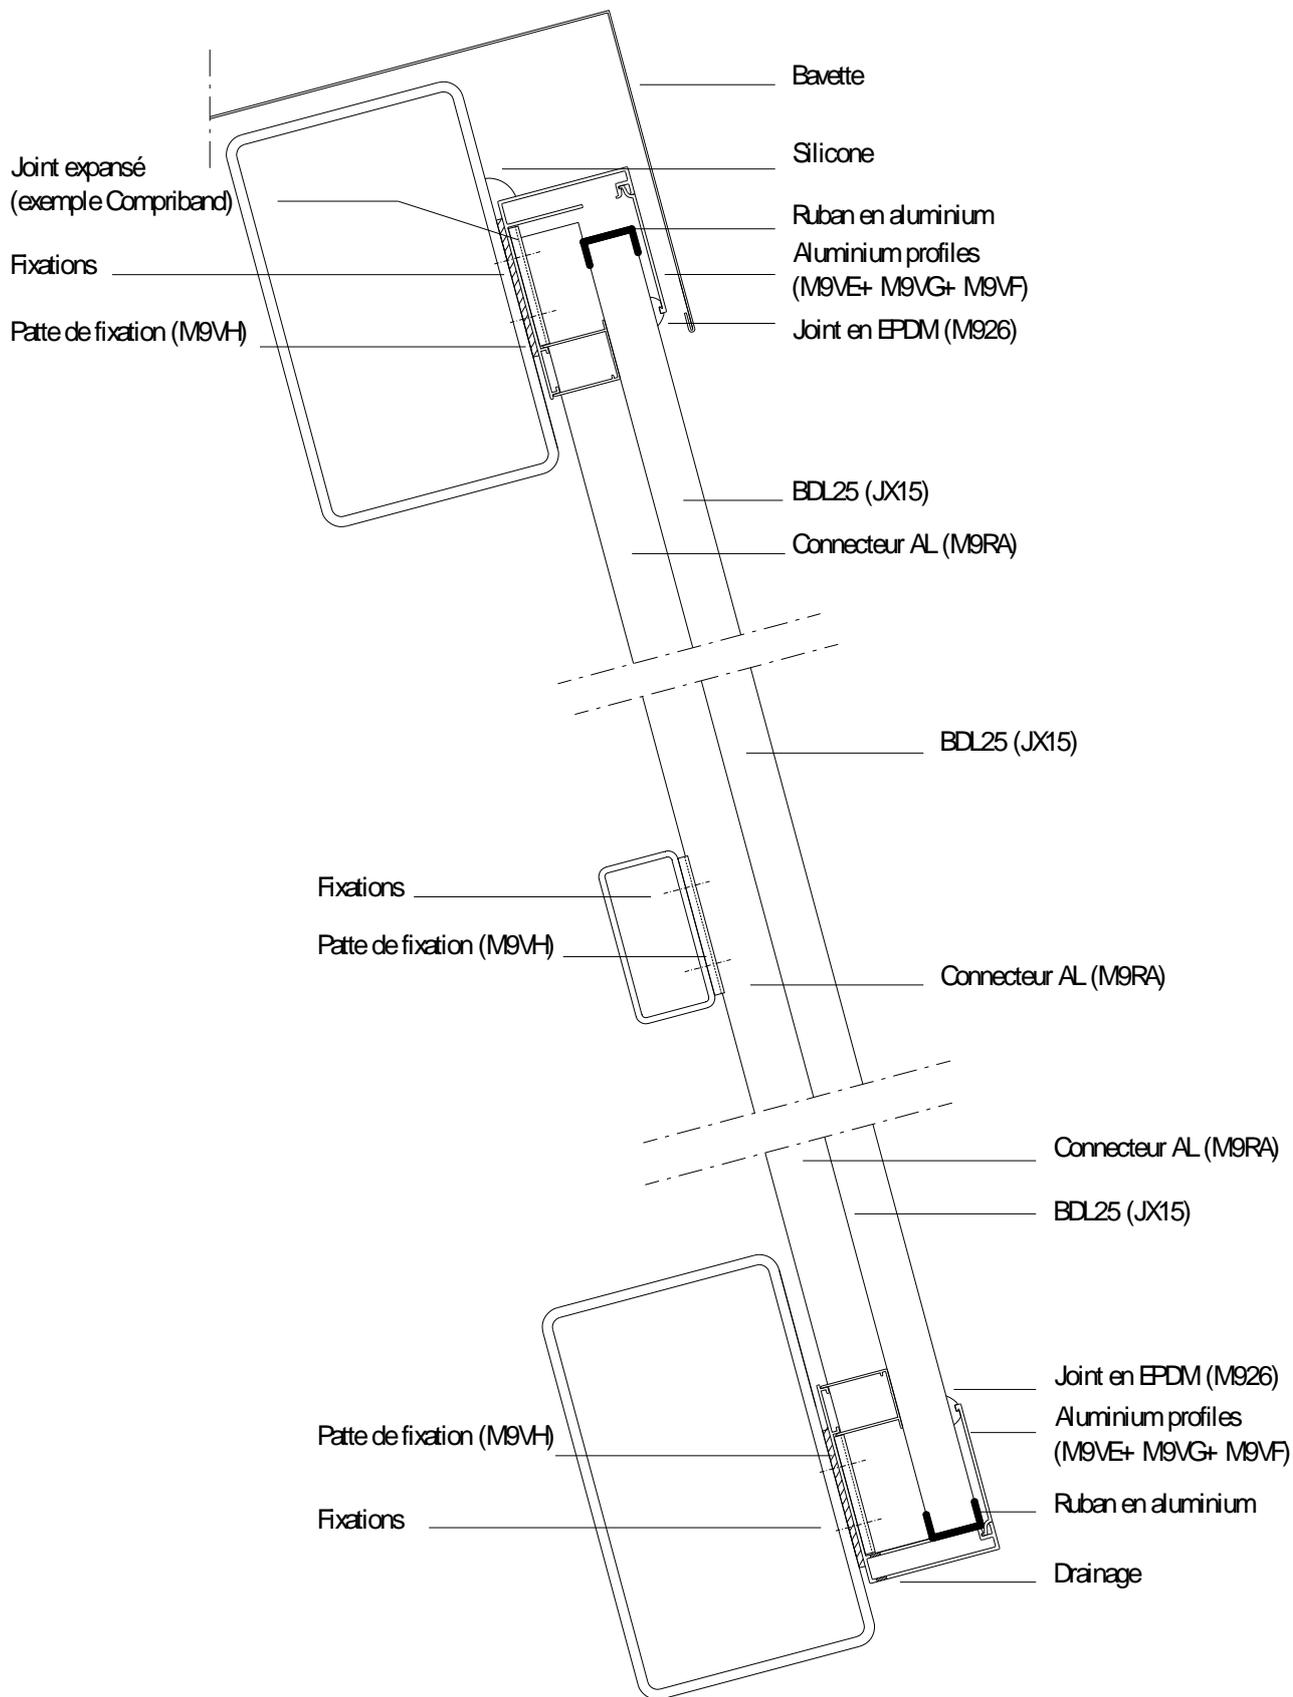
Application inclinée BDL25 avec hauteur limitée à 6,0 m (connecteur en aluminium)
